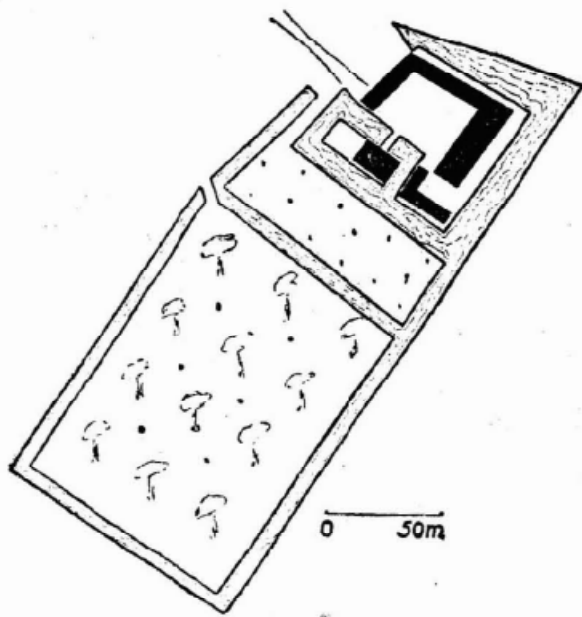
Lageplan von Haus Pesch im Jahre 1823
